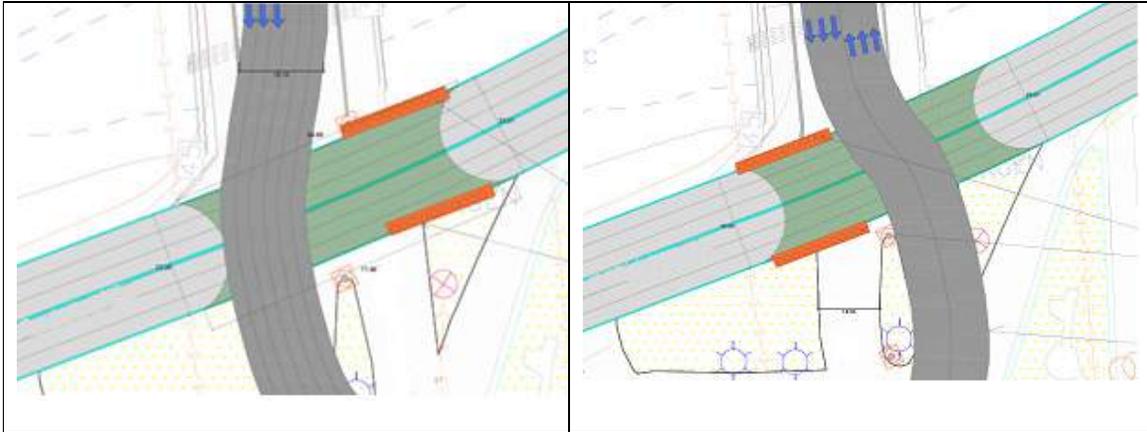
Esquema de procedimiento constructivo de By-pass mediante muros de pilotes en las zonas de puentes
